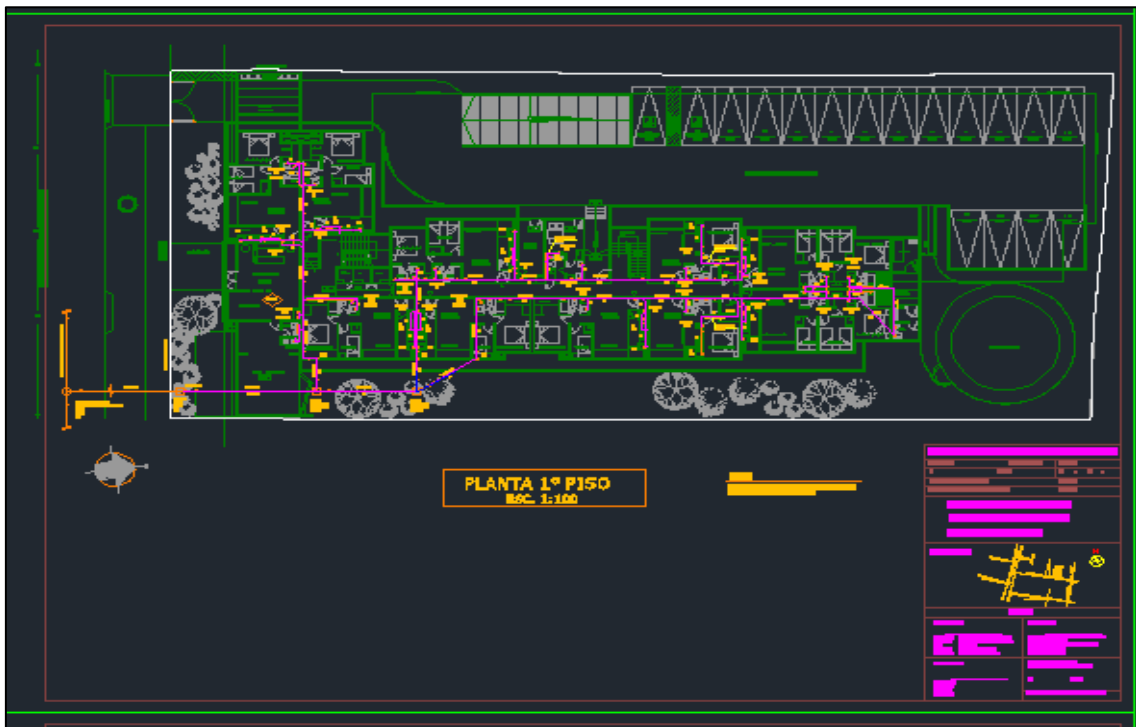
Planos As Built, Alcantarillado Piso Nª 1
